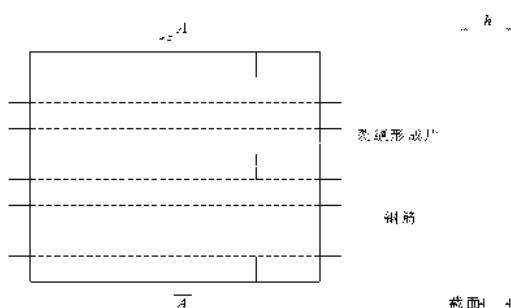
开裂混凝土试件配筋及裂缝形成片
